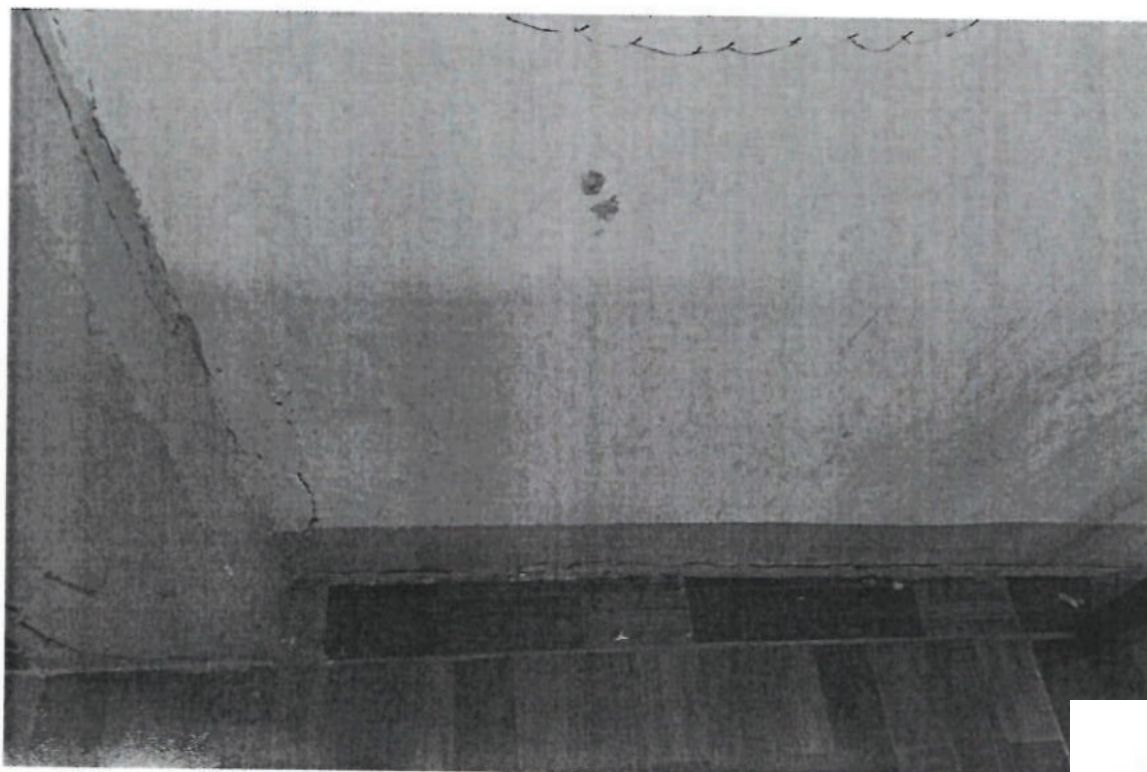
(Vista interior) Presenta fisuras superficiales en encuentros de muros con columnas y pisos.
